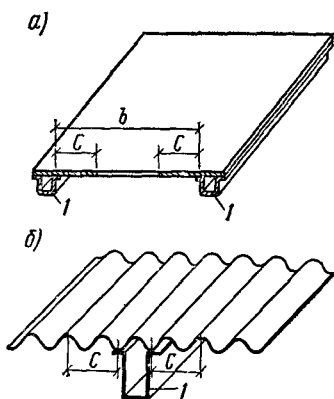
Расчетная схема листов, усиленных продольными ребрами
